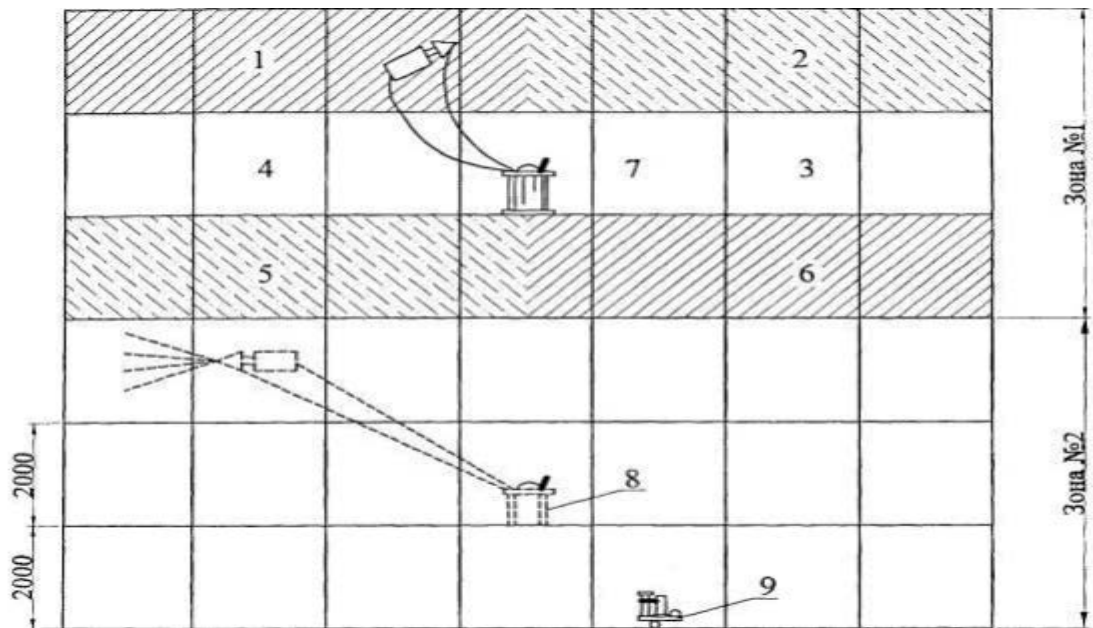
Схема розподілу забарвлення по ярусах риштувань, зон і захватками: 1-6 – захватки; 7 – бачок з фарбою для фарбування зони №1;
